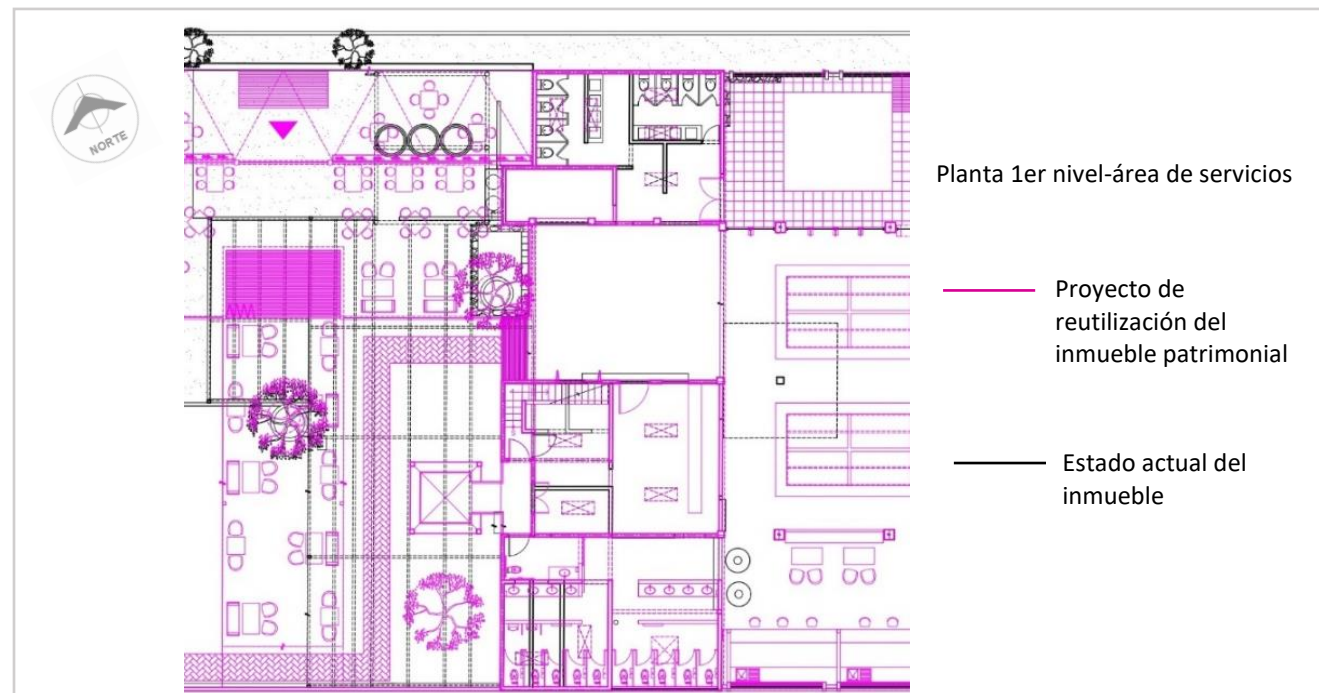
Superposición de planta de proyecto de reutilización sobre planta del estado actual del inmueble (Elaboración propia).
